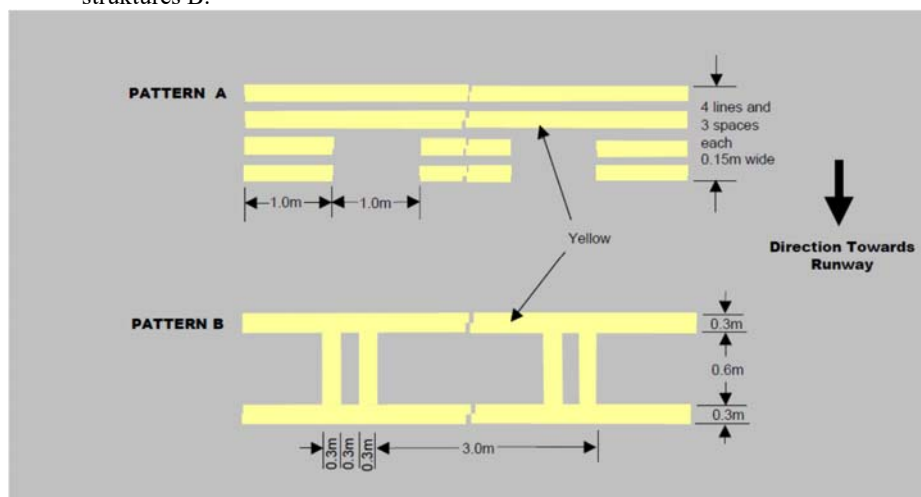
Struktura A dhe struktura B i vijëzimeve të pozicioneve të ndalimit të pistës
